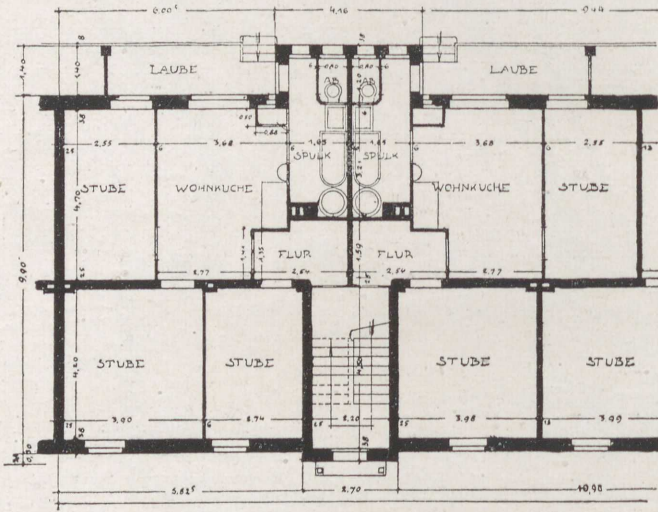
Grundriß der Siedlung Kolonie Lindenhof in Schöneberg.
